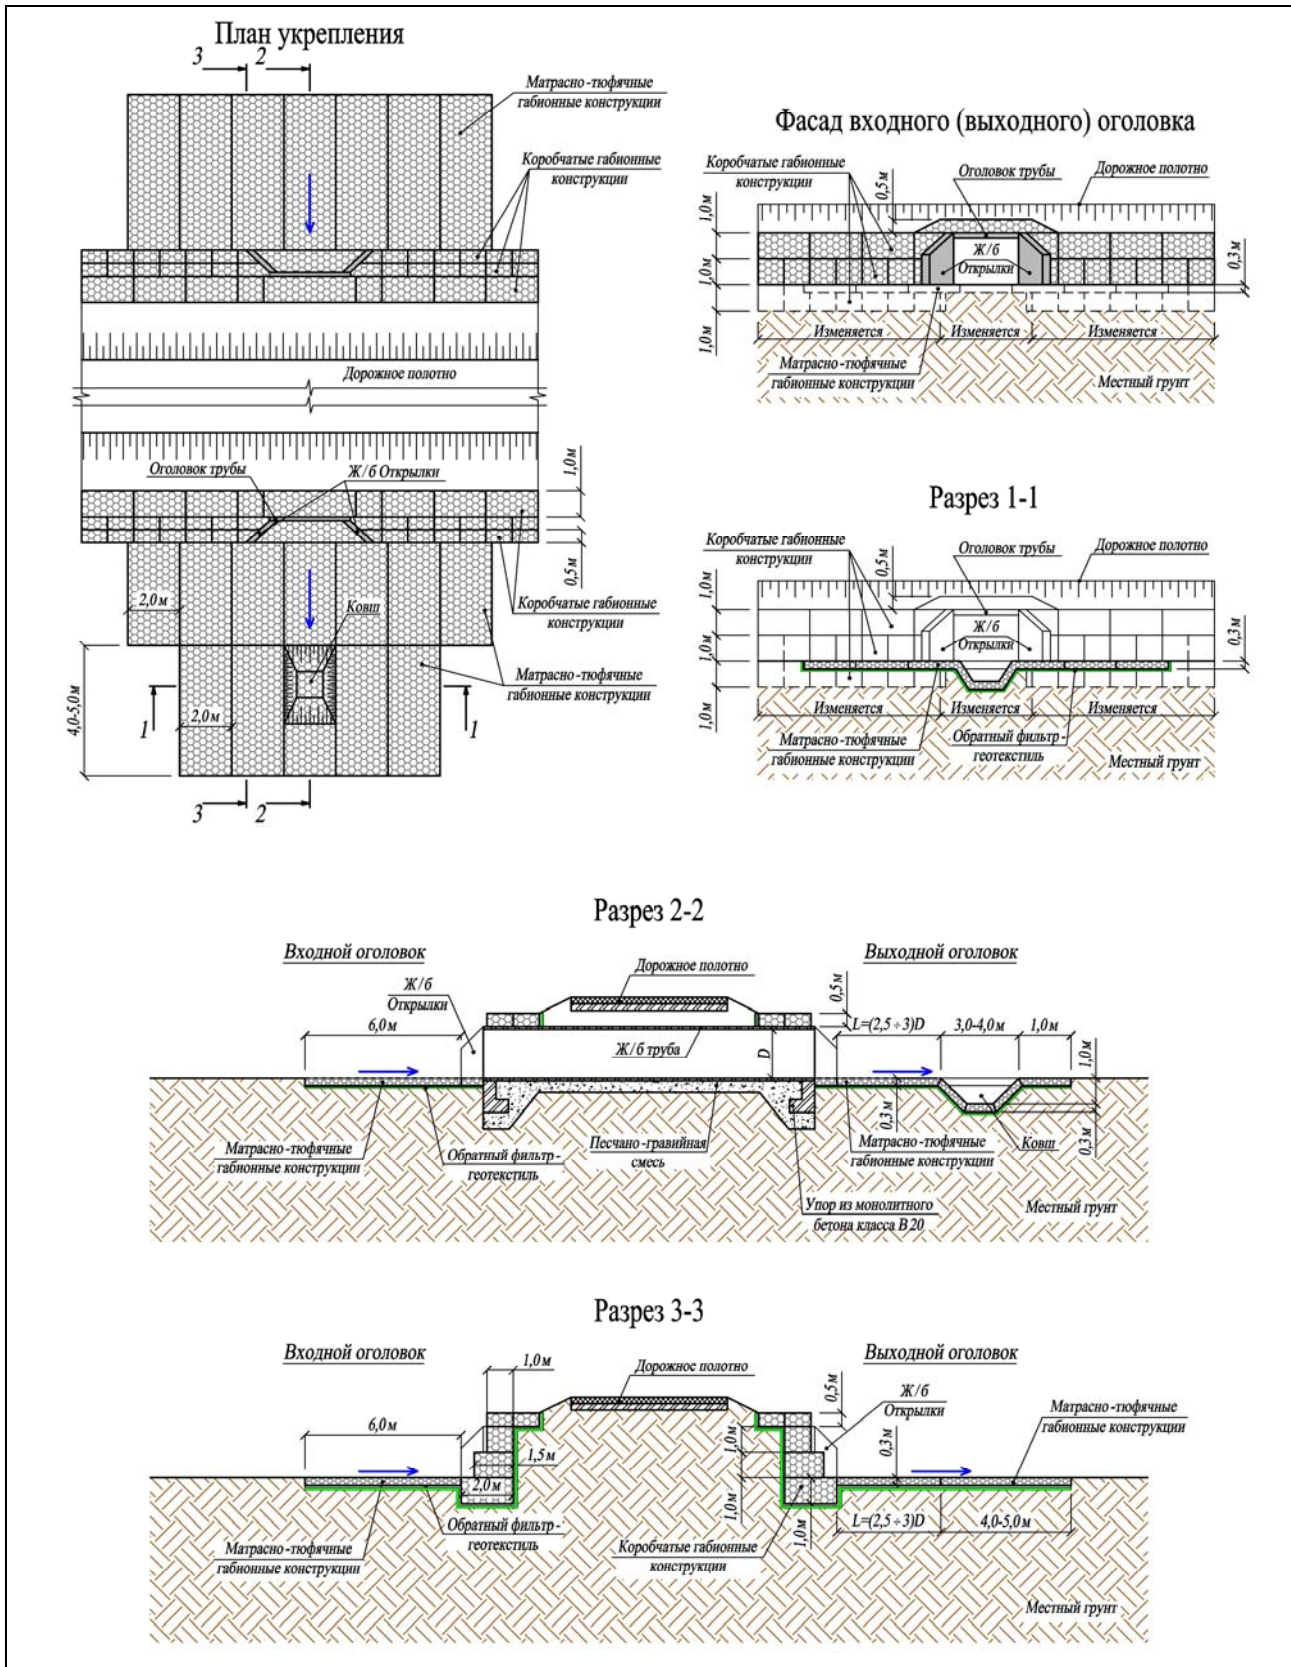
Укрепление оголовков водопропускной трубы и дорожных откосов подпорной стеной из коробчатых габионных конструкций
